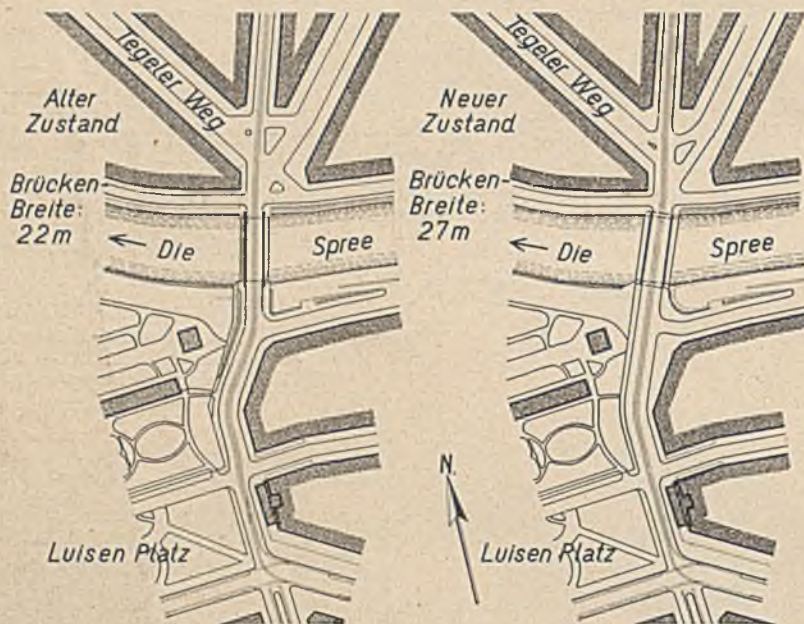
Schloßbrücke in Charlottenburg. — Lageplan.
